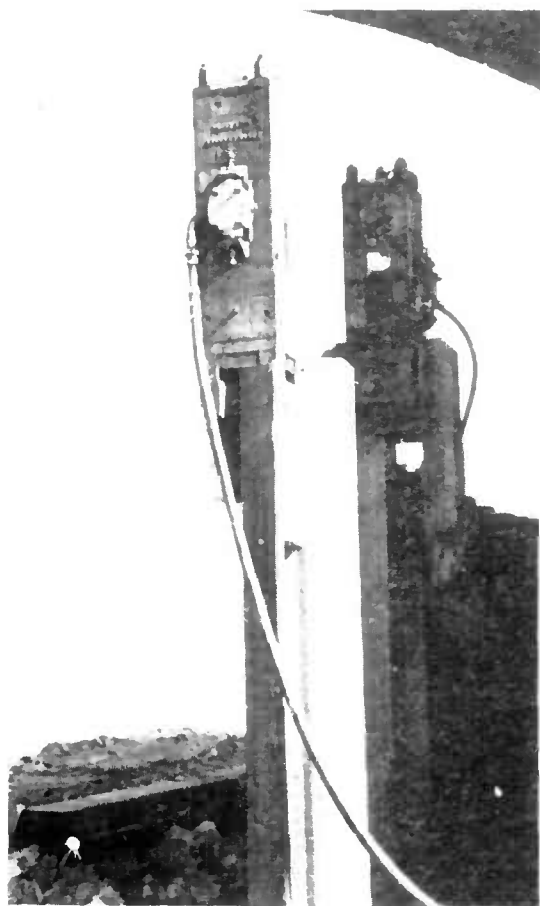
Battage sous voûte à l'aide d'un petit marteau trépideur. Les palplanches sont entées et soudées pour obtenir la longueur voulue
